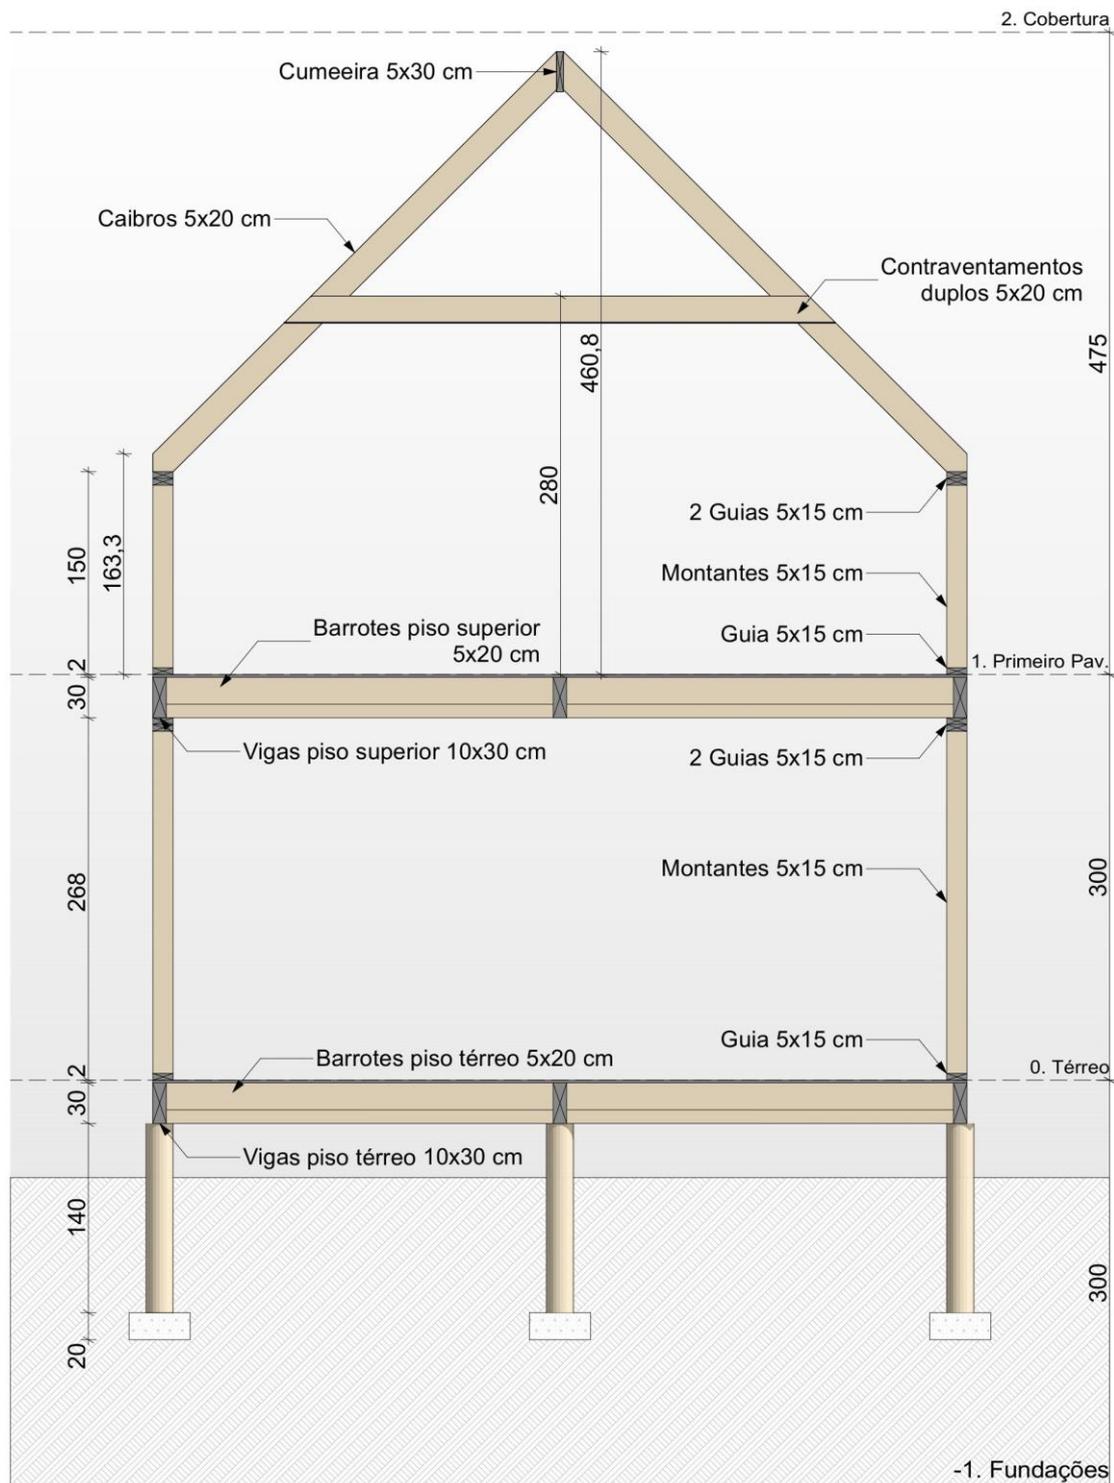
corte esquemático solução proposta para encontro parede e piso
